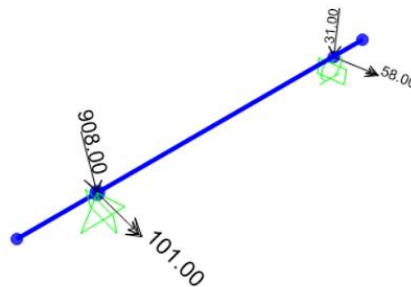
Esforços da Estrutura metálica sobre a sapata
